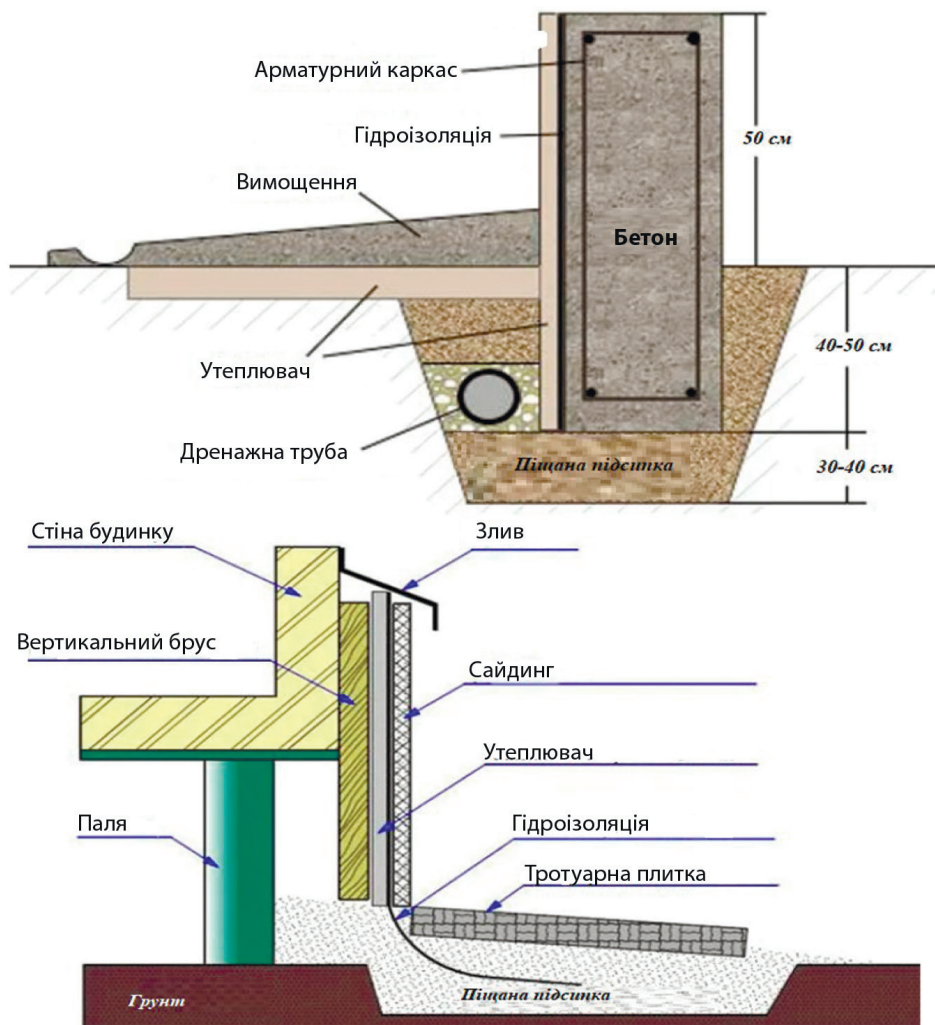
Влаштування утеплення та гідроізоляції фундаменту будинку за різних конструктивних типів фундаменту
